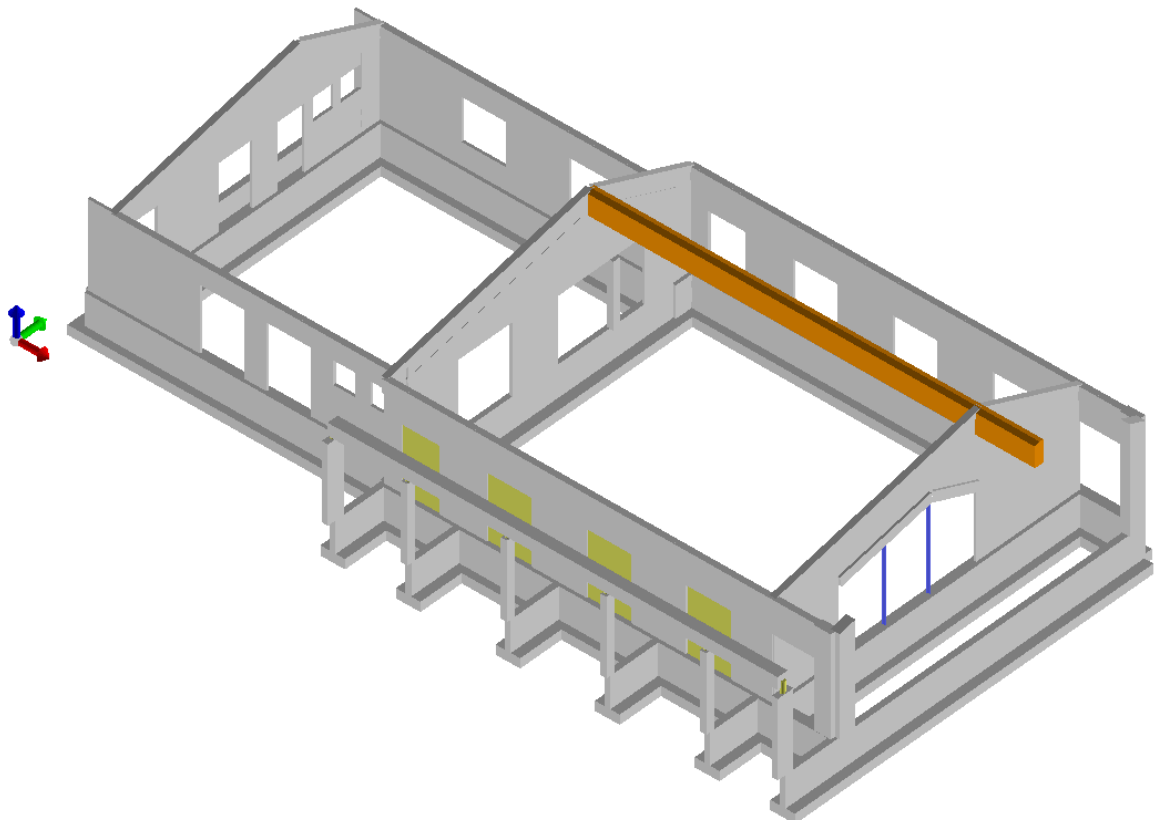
Modello Strutturale Vista solida - vista assometrica 1 .
